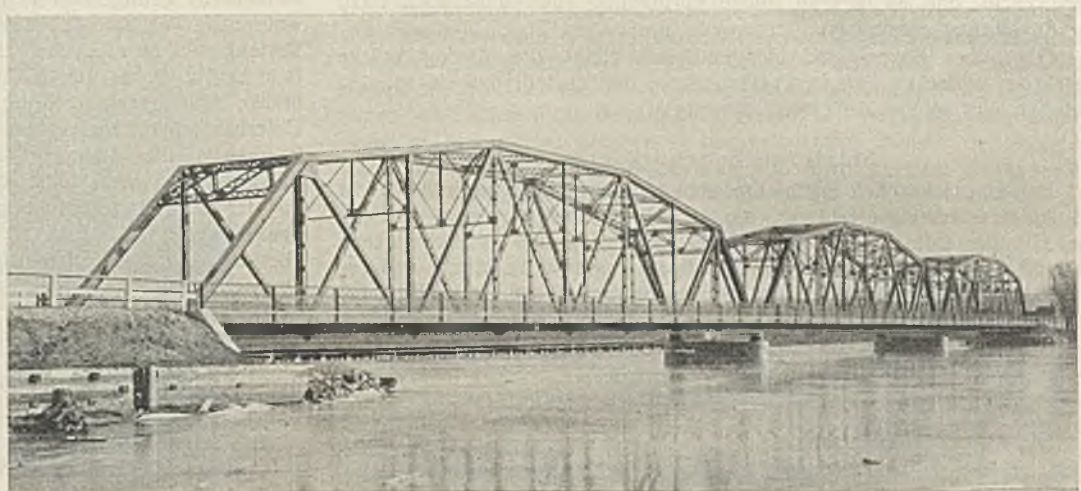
Einfache Landbrücke, Straßenbrücke mit Fahrbahn unten.
